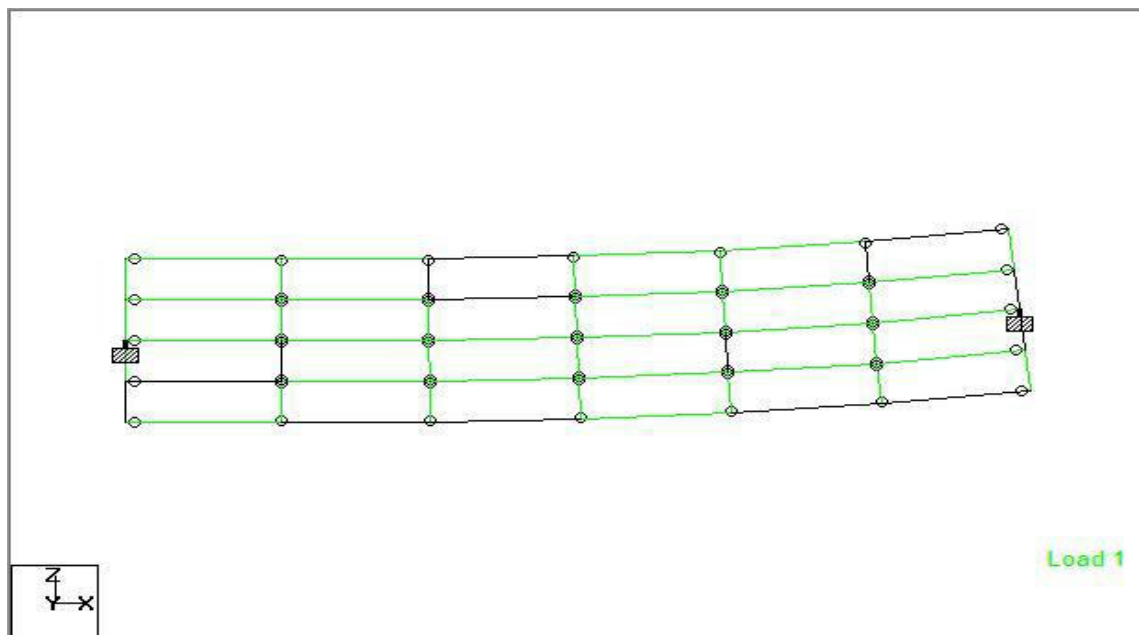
Vista en Planta del Modelo del puente usando el método del entramado plano.
